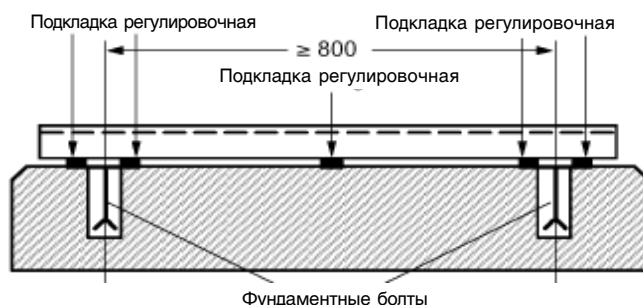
Размещение регулировочных прокладок под опорной плитой
